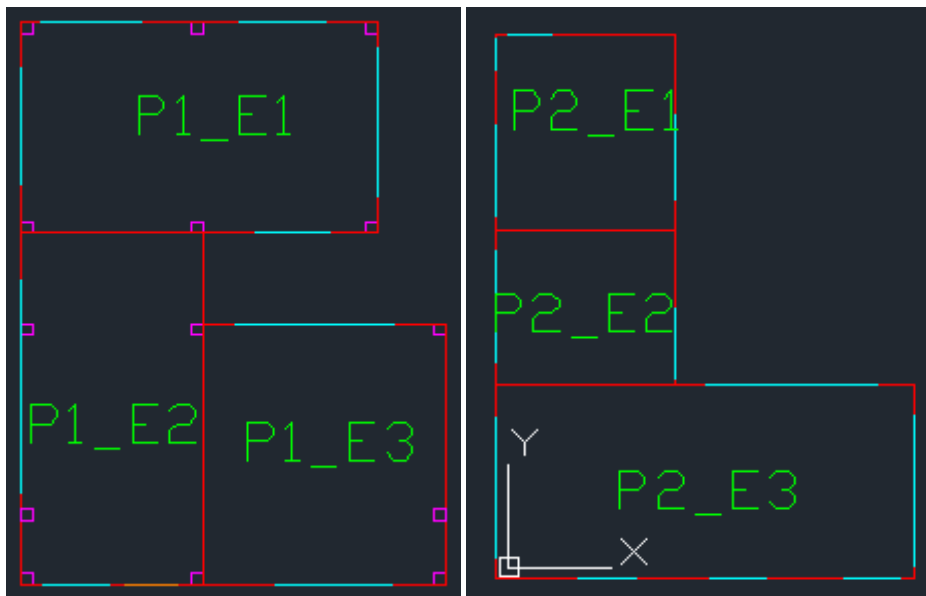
Planta baja y planta superior de la vivienda unifamiliar
